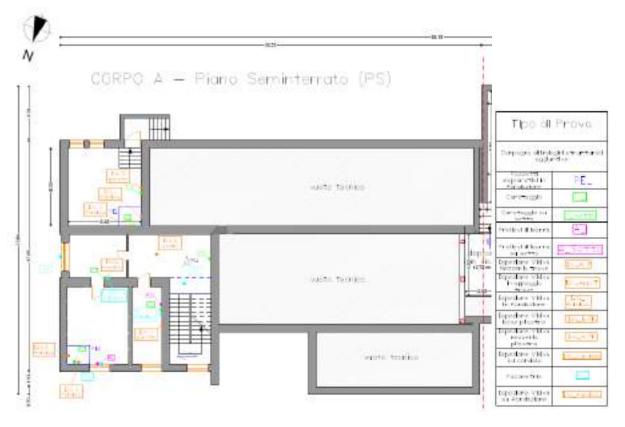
Planimetrie strutturali con localizzazione delle prove effettuate in sito - Pianta Piano Seminterrato - Corpo A - Campagna di indagini strutturali 2023
